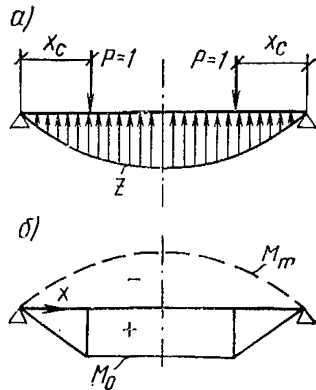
К расчету на сосредоточенную поперечную нагрузку
